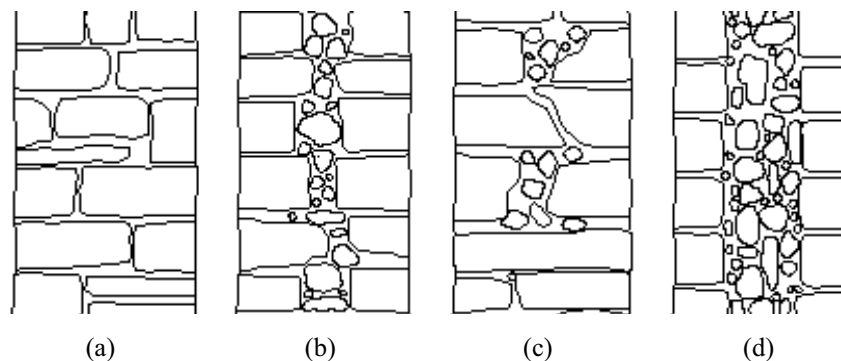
Secções transversais de paredes de alvenaria de pedra antigas (Roque, 2002): (a) parede simples; (b) parede de dois panos sem ligação; (c) parede de dois panos com ligação; (d) parede de três panos.
